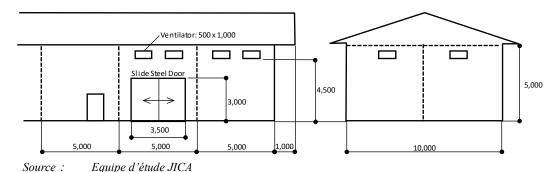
Vue de face et vue de côté du magasin de stockage de céréales
